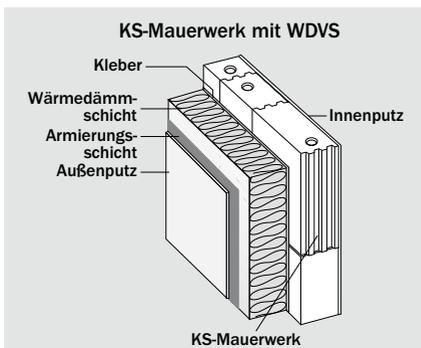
/26: KS-Mauerwerk ist ein idealer Untergrund für jedes Wärmedämm-Verbundsystem.
